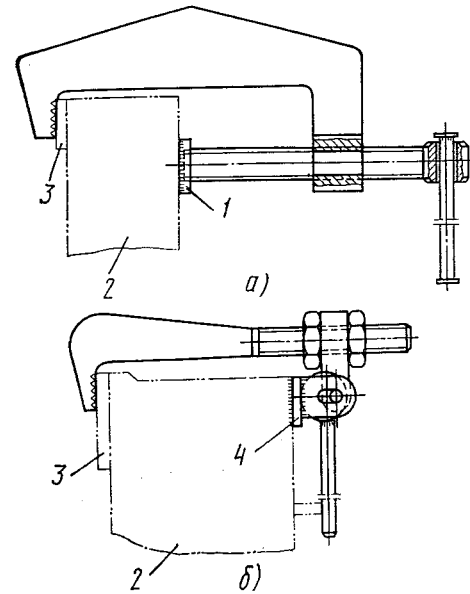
Фиксаторы для крепления закладных деталей с использованием только сил трения:
